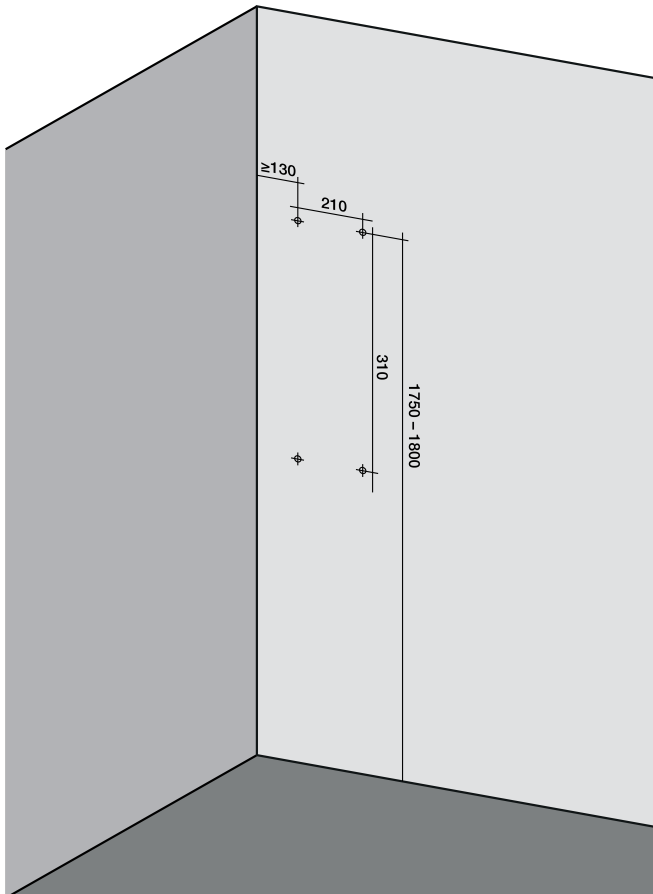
Montagemaße des externen Subverteilers ONLITE central eBox SUB E30
